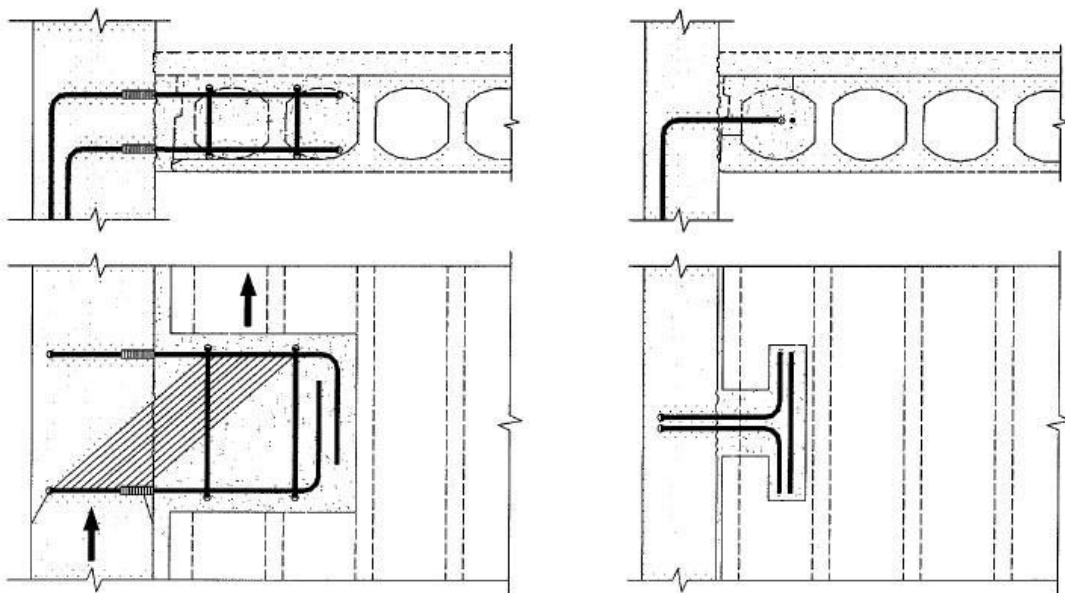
Ligação longitudinal entre uma laje alveolar e uma parede resistente [26]
